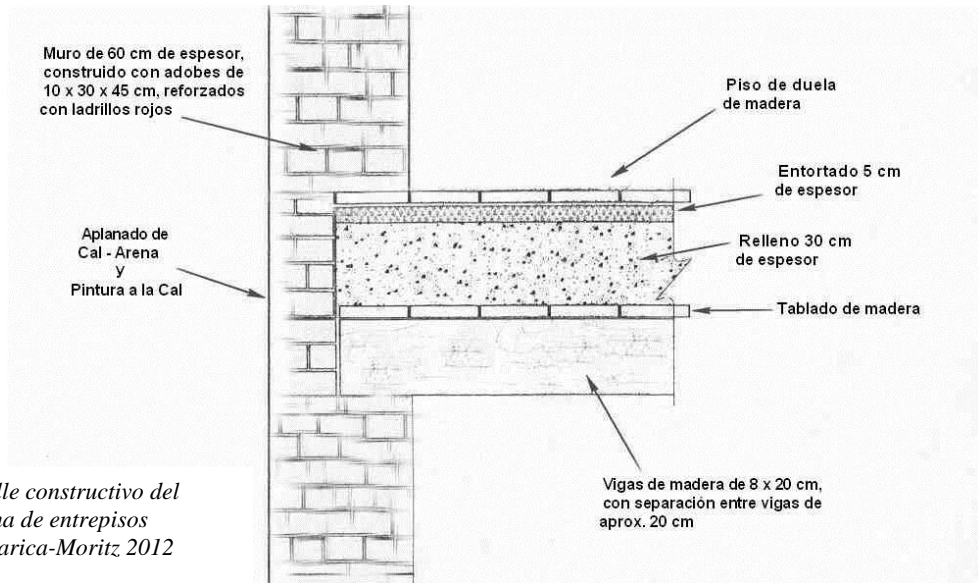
Detalle constructivo del posible sistema de entrepisos
